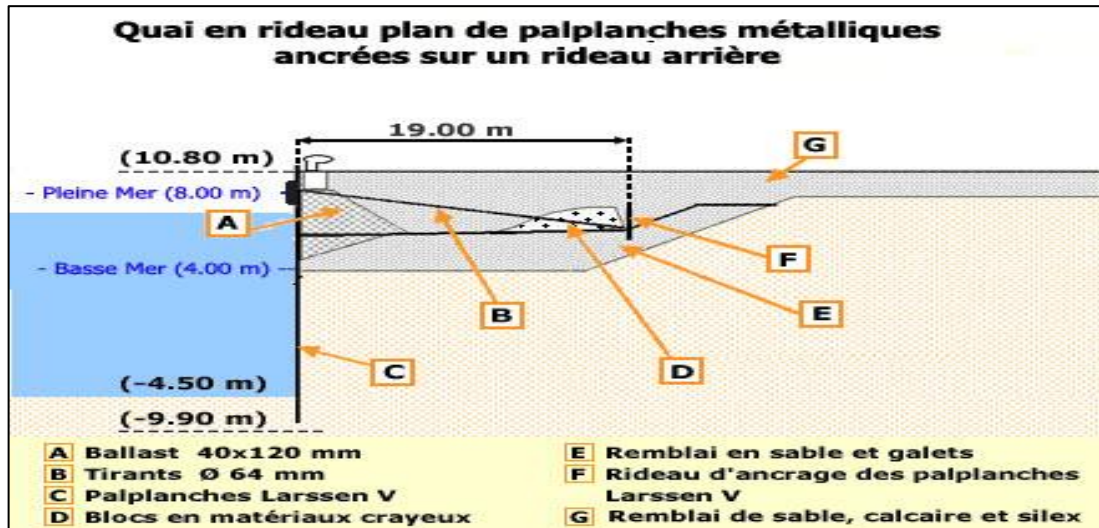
Schéma d'un quai en rideau plan de palplanches métalliques ancrées sur un rideau arrière
